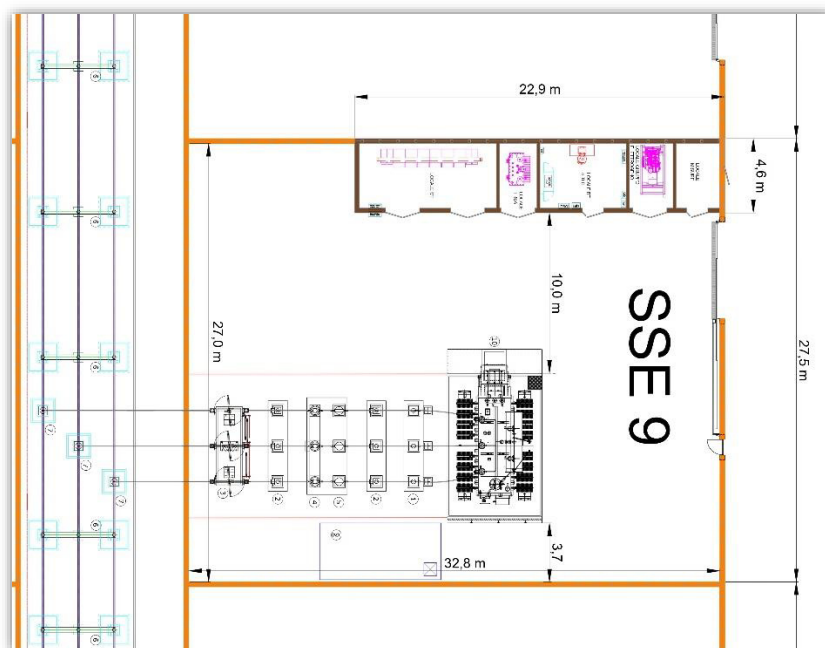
Planimetria elettromeccanica della Sottostazione Elettrica di Utenza, con stralcio delle sbarre principali per la condivisione di Stallo.
